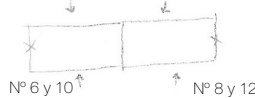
Bocetos en planta de la disposición de las construcciones situadas en la Rúa Vilagarcía de Arousa, nº 6, 8, 10 y 12 (autoría propia).
